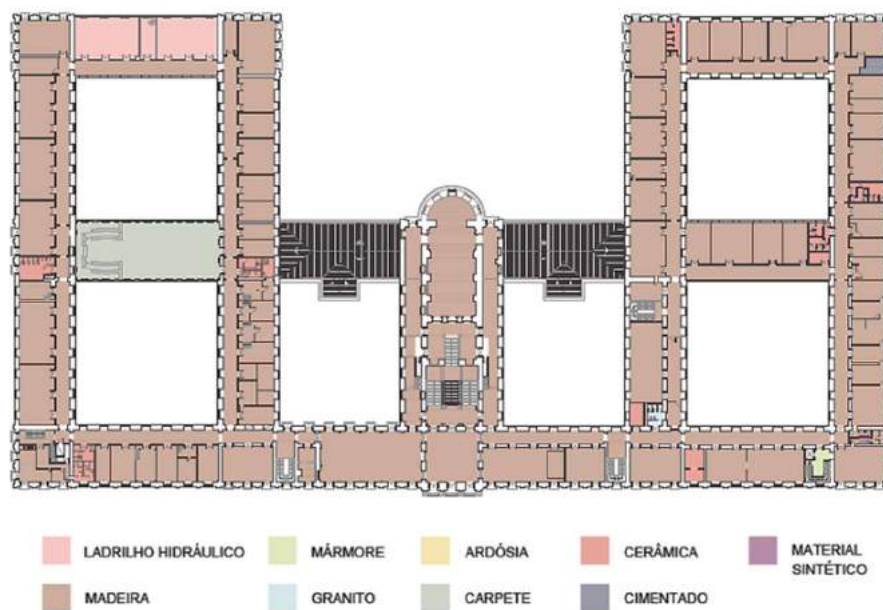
Planta esquemática de tipos de pisos do segundo pavimento do Palácio Universitário.
